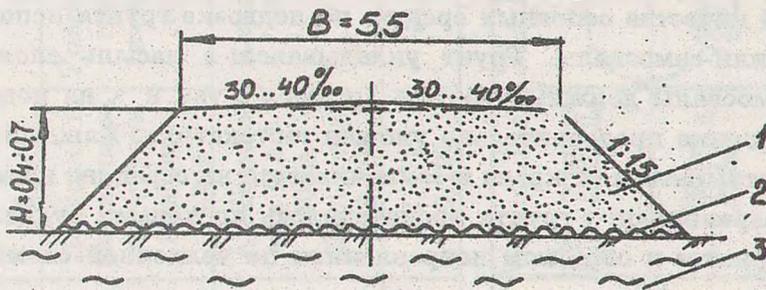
Схема дорожной конструкции: 1 - привозной грунт; 2 - прослойка геотекстиля; 3 - слабый грунт
